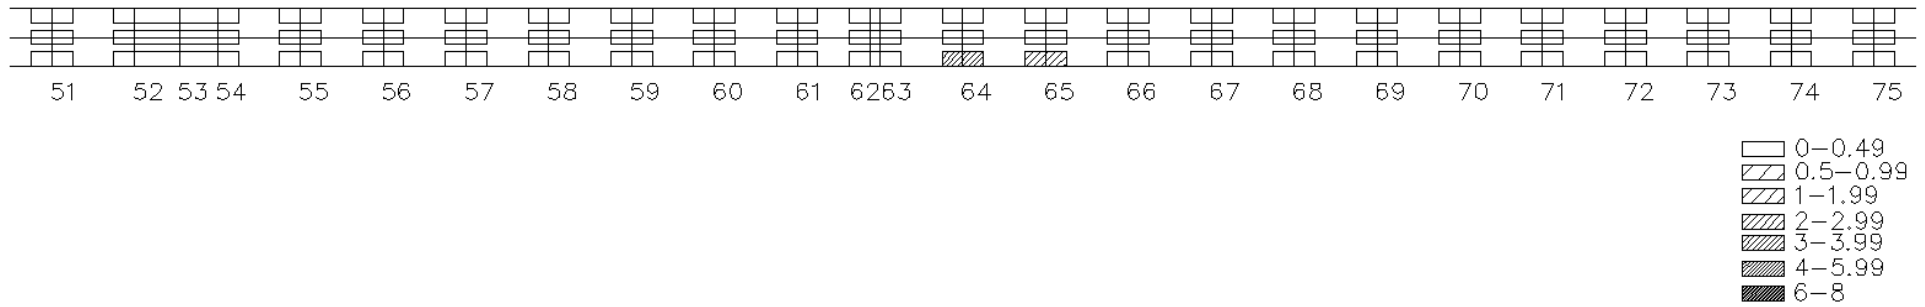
Frästiefen bei Tangenten und quadratischen Parabeln und Verfahrensplan Typ V, Grundriss, Stationen 51-75
